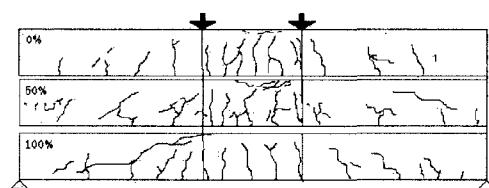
ひび割れ発生状況 ($a/d=4$)
